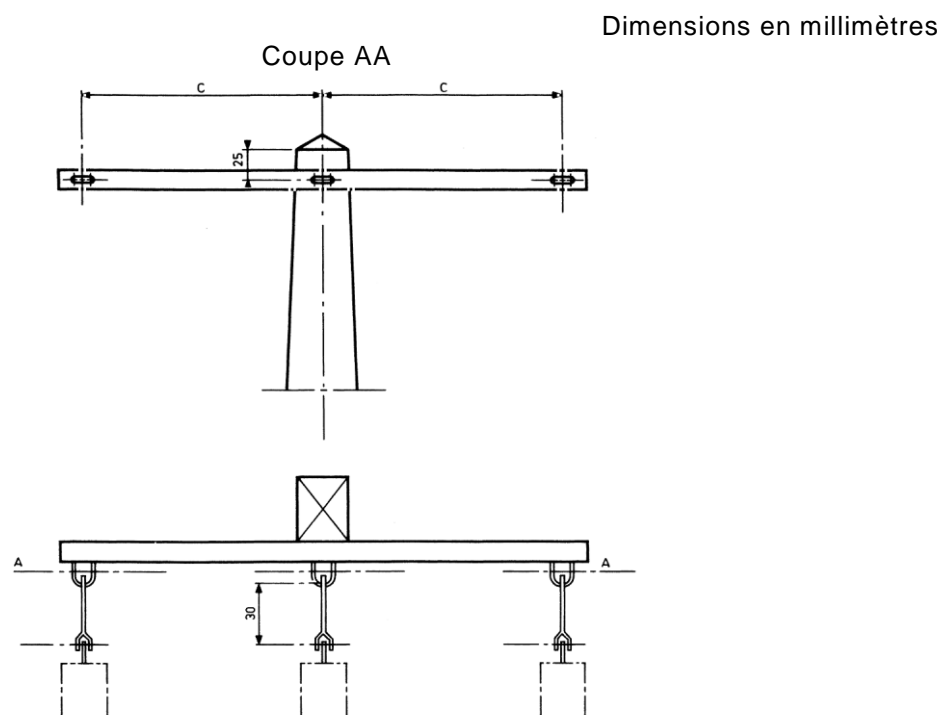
D – Poste sur poteau (Ferrure d'ancrage de la ligne haute tension)
